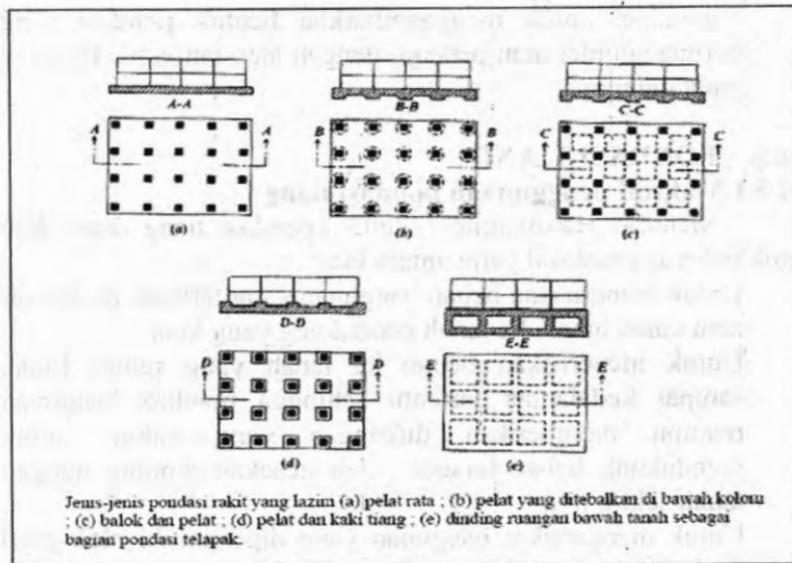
Gambar jenis-jenis pondasi telapak (Bowles, 1996)
